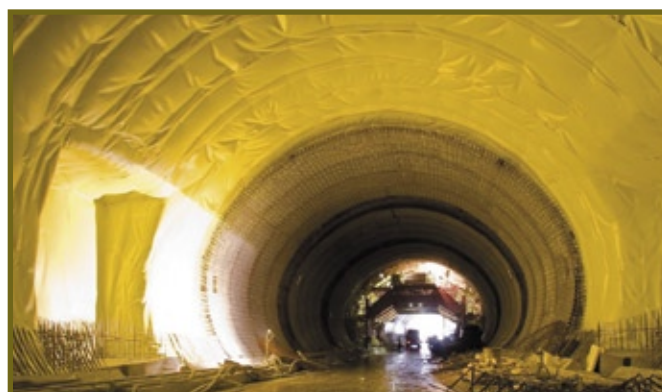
Narzut torkretu w celu stabilizacji ściany i zabezpieczenia przed napływem wody gruntowej.
